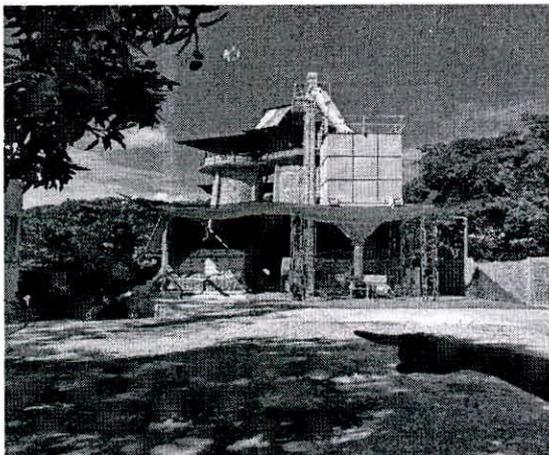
Entrada principal a la planta de transformación de minerales no metálicos de la empresa MINERALES DEL SUR 2.
